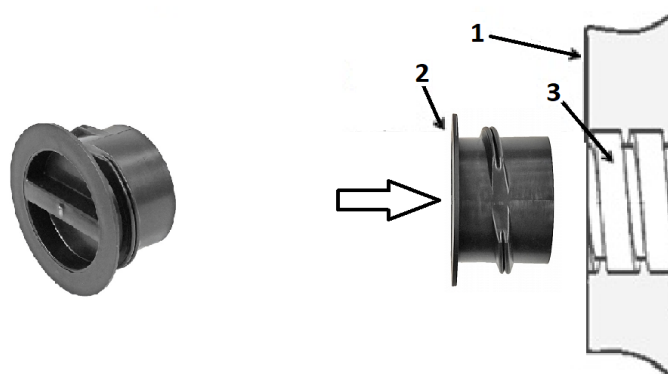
Закрывание свободного отверстия с муфтой внутренней заглушкой для муфты:
